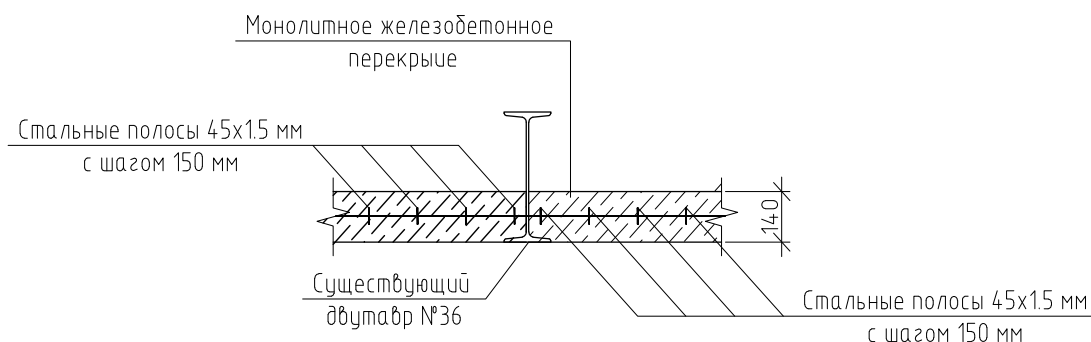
Схема узла 4 (разработал Н.К. Ананьева)
